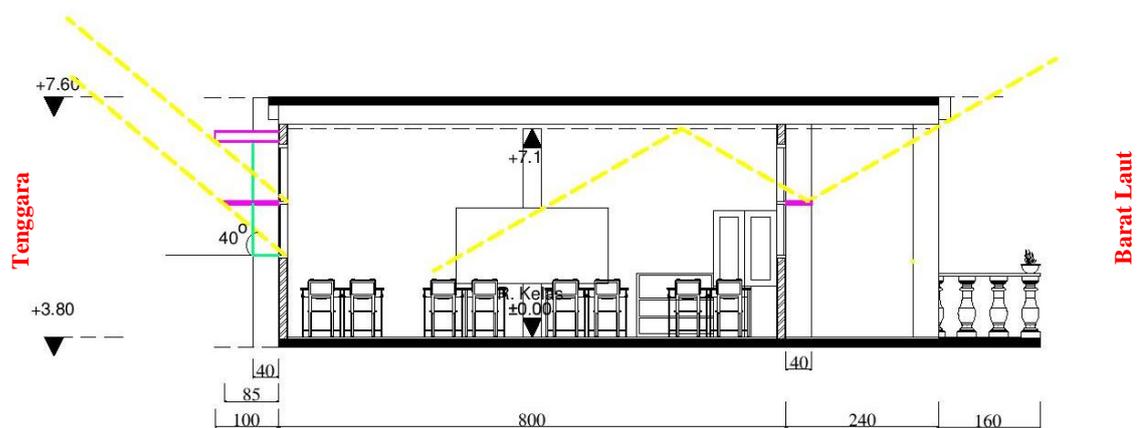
Tampak Tenggara dan Barat Laut Ruang Alternatif 2 Rekomendasi Eksternal II
